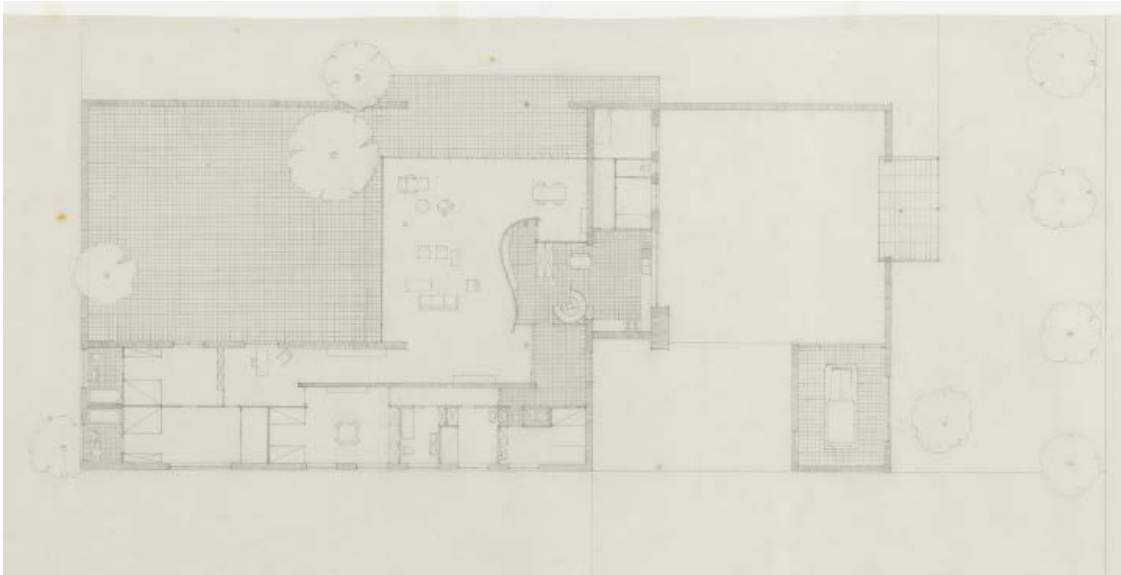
Planta baixa versão final, Casa Lange, 1935.
